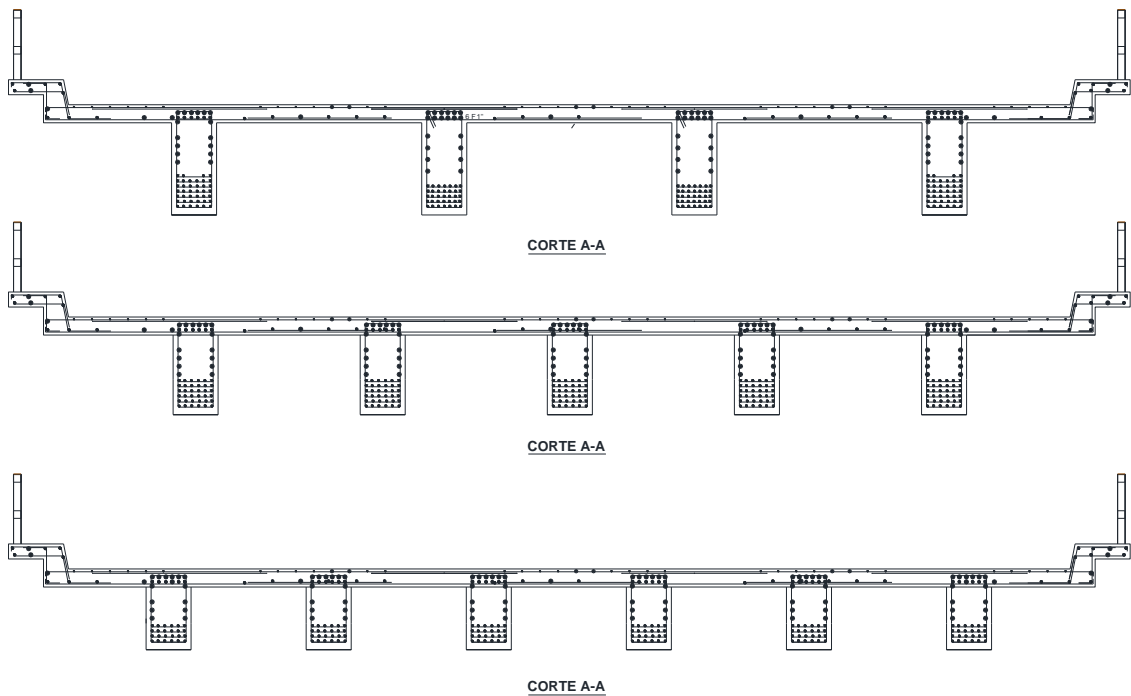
Puente Viga-Losa, con vigas 4,5 y 6 longitudinales.
